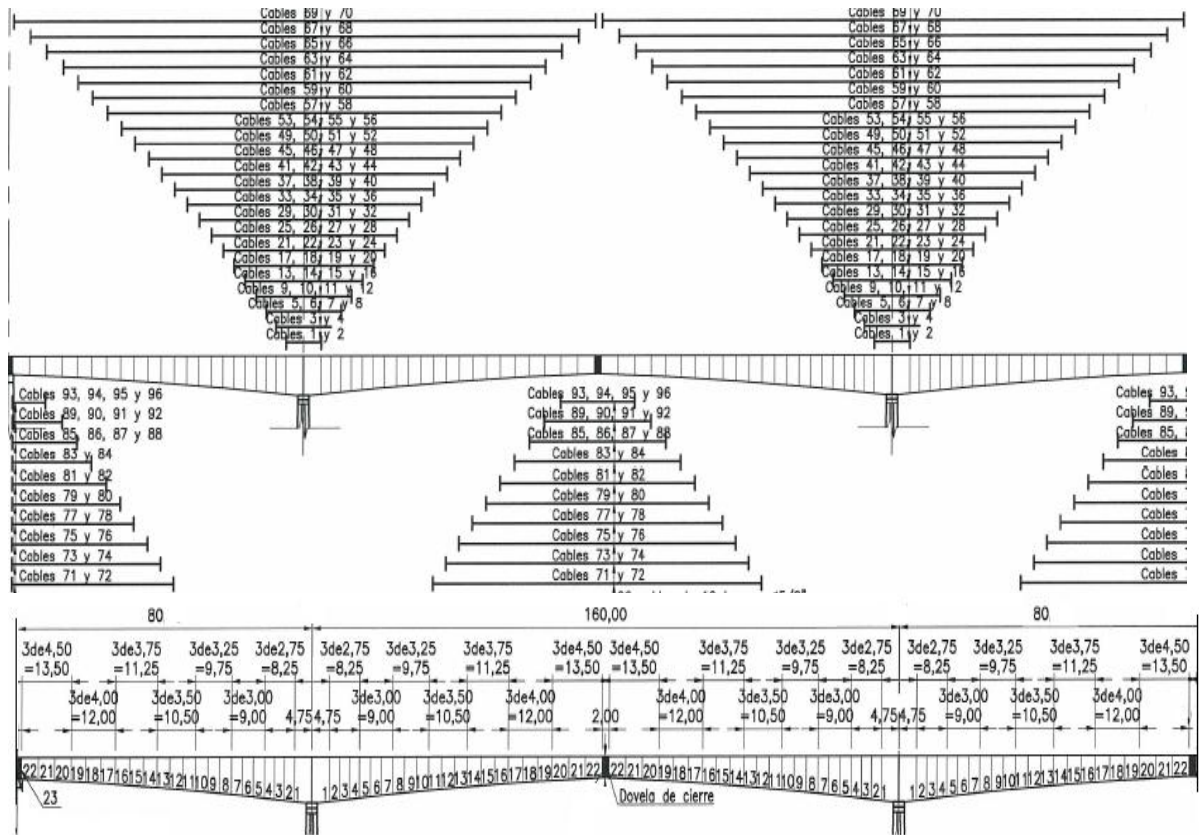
Vista longitudinal del puente y distribución de los cables de presfuerzo.
